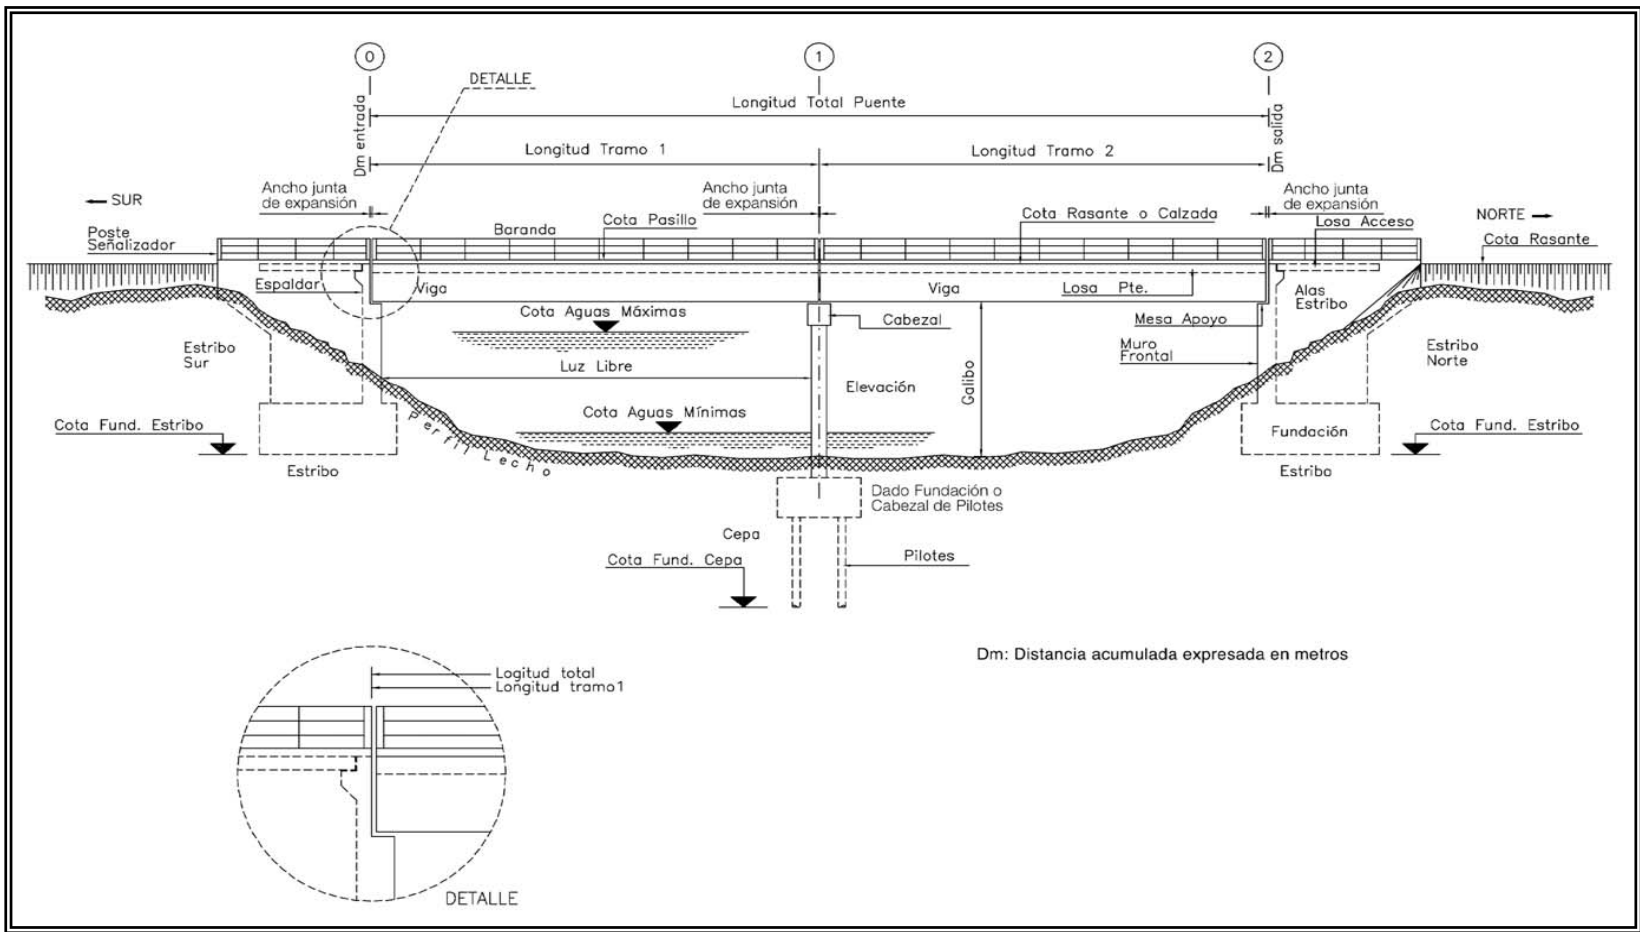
Dibujo que muestra las partes constituyentes de un puente tipo.
